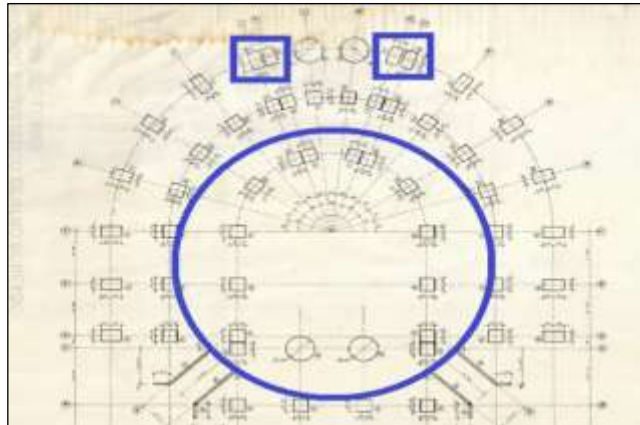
Fuente: autores, (mayo de 2018). Plano de cimentación de primer piso, plano original elaborado por Ing. Carlos Navas Camargo, alcaldía municipal Yopal.
